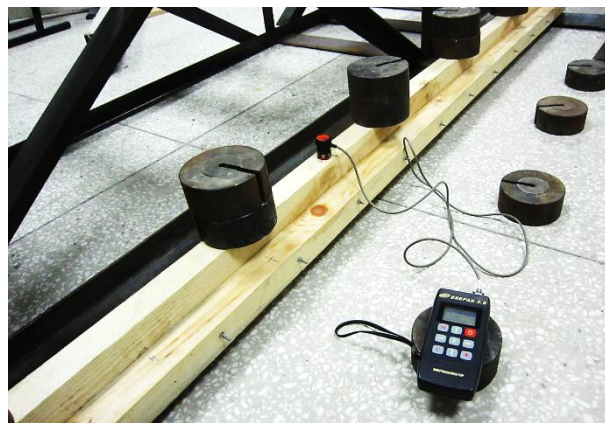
Испытание тавровой балки на динамическую нагрузку
